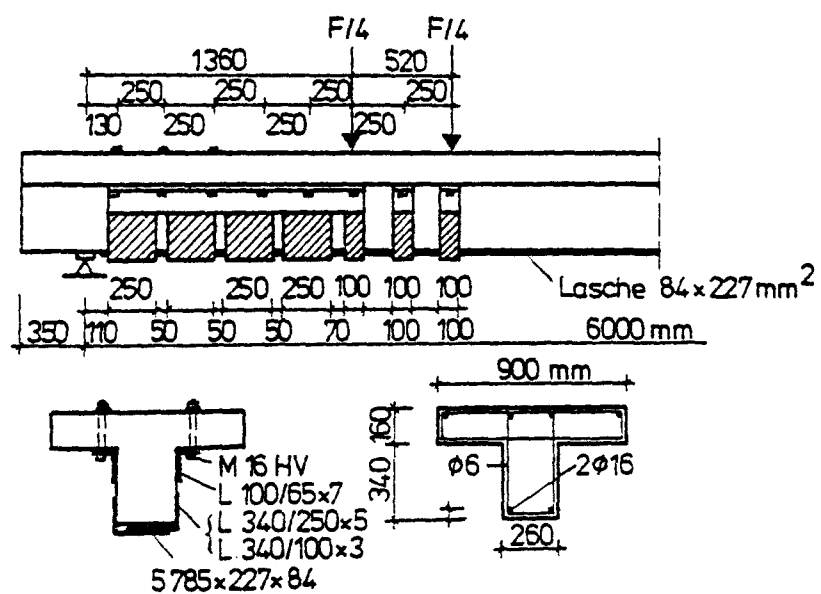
Plattenbalken mit geklebter Bewehrung nach
